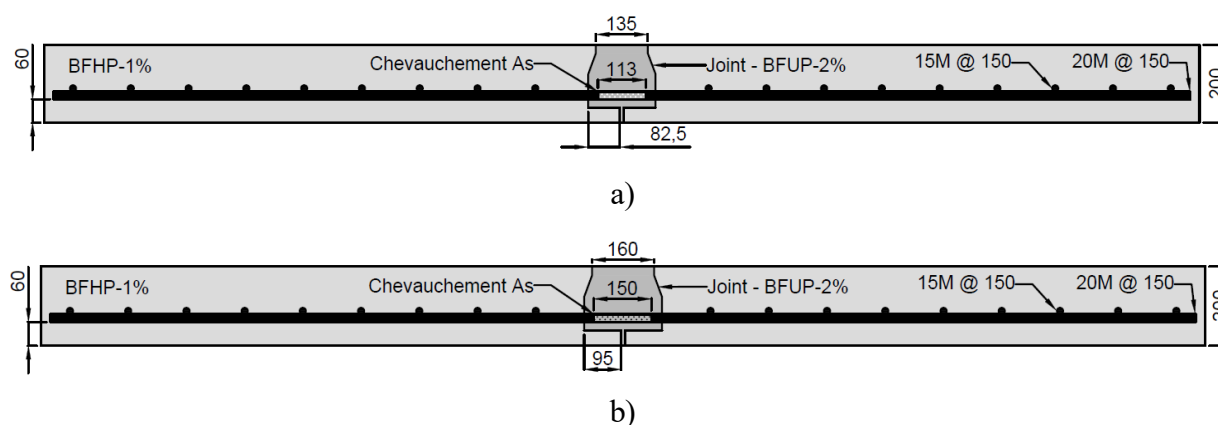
Dalle en BFHP avec joint de connexion longitudinal en BFUP, a) Joint de 175 mm, b) Joint de 200 mm
